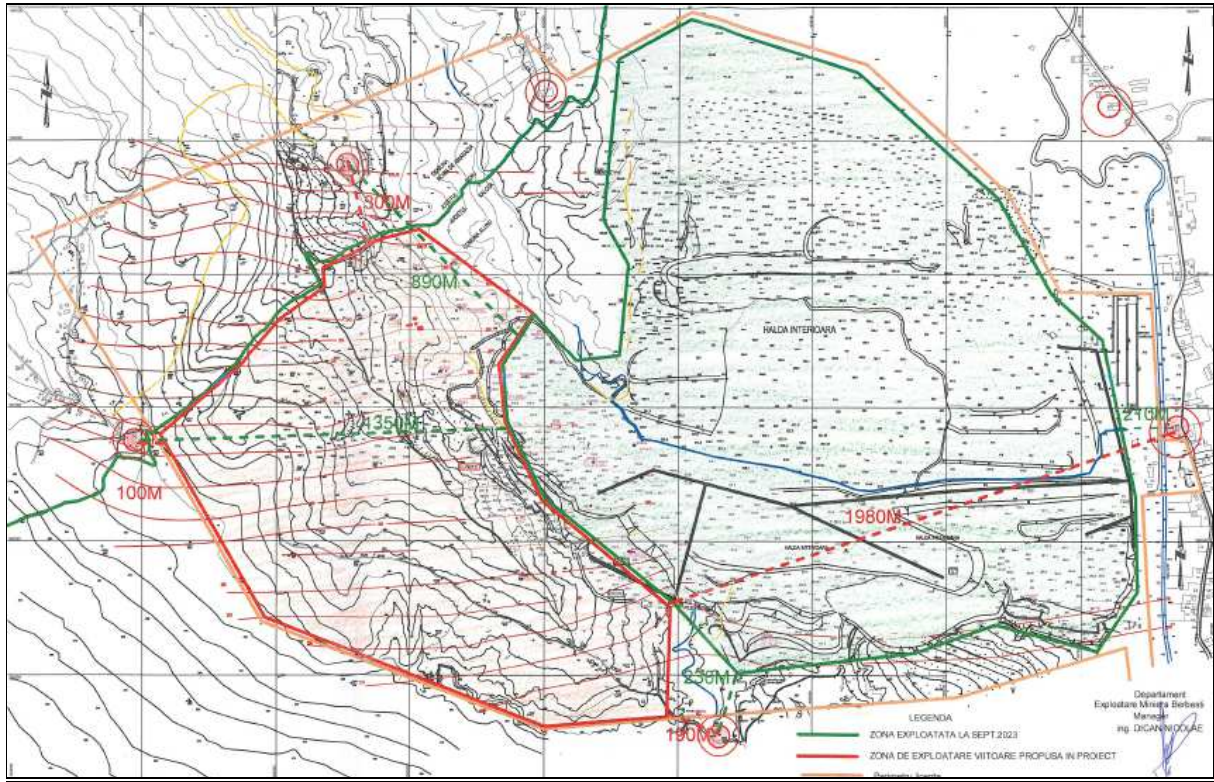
Plan de situație – scara 1 : 10.000
